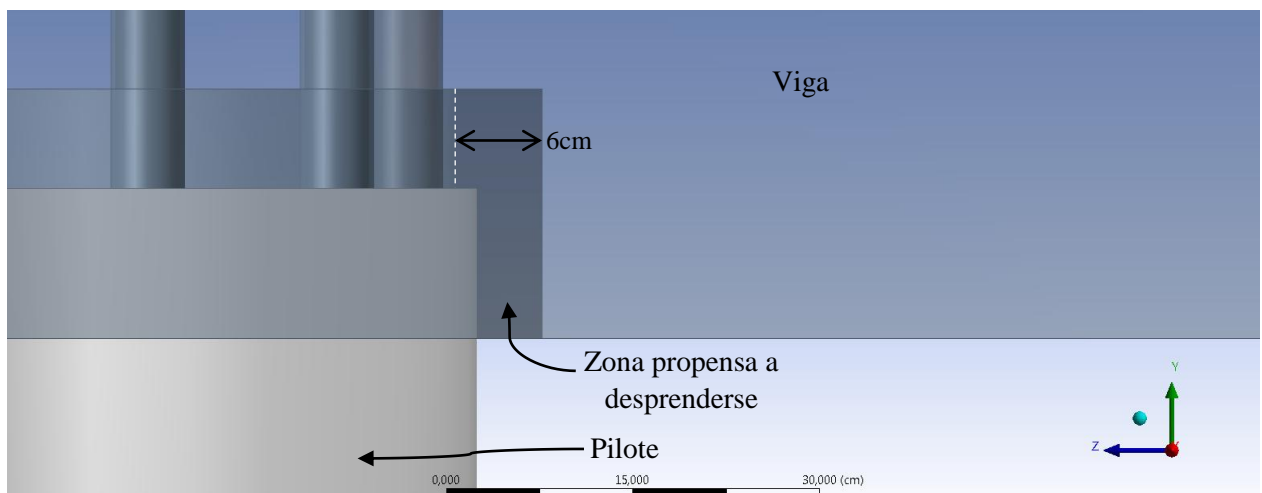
Detalle de la zona de intrusión del pilote vertical en la viga de hormigón armado.
